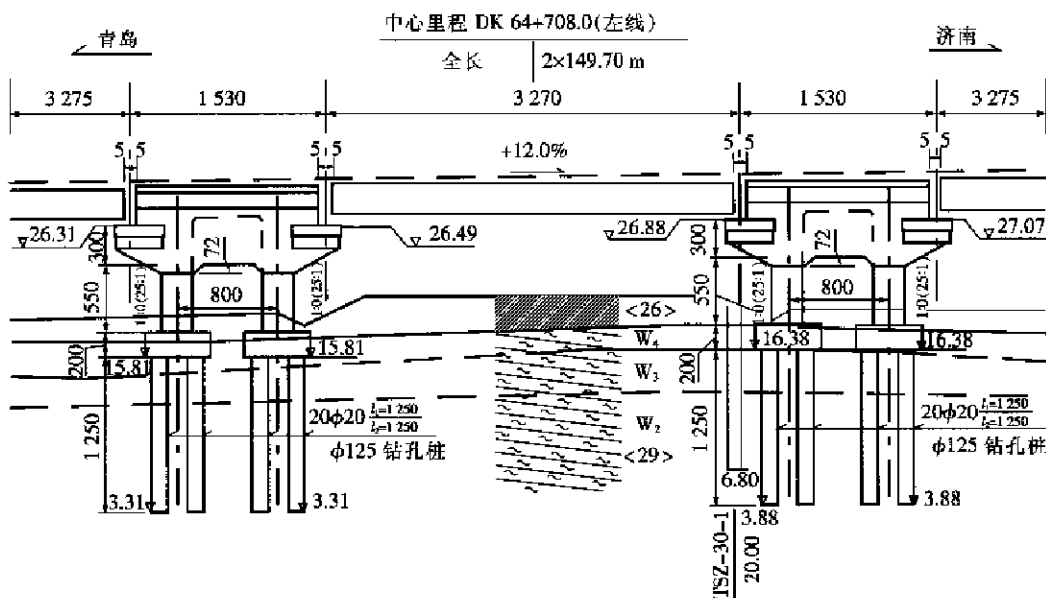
纵向双悬臂刚架墩立面图(除标高外单位均为 mm)
